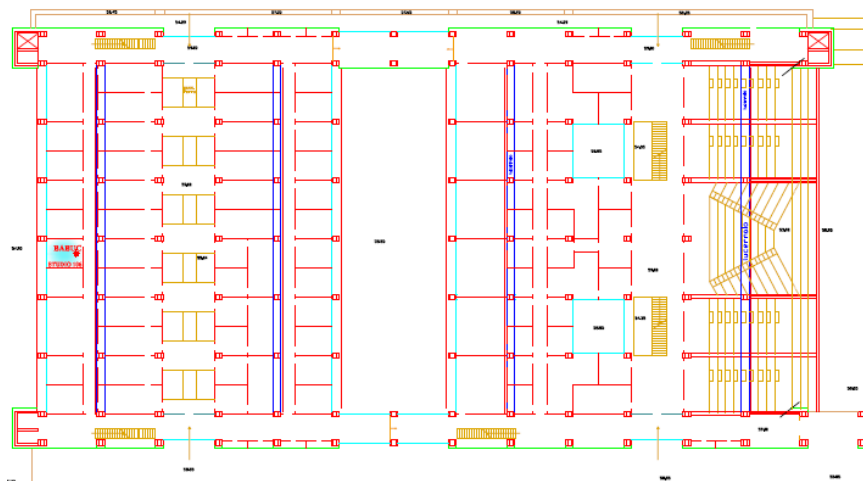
Edificio 17, Collocazione in pianta dello Studio n°106
